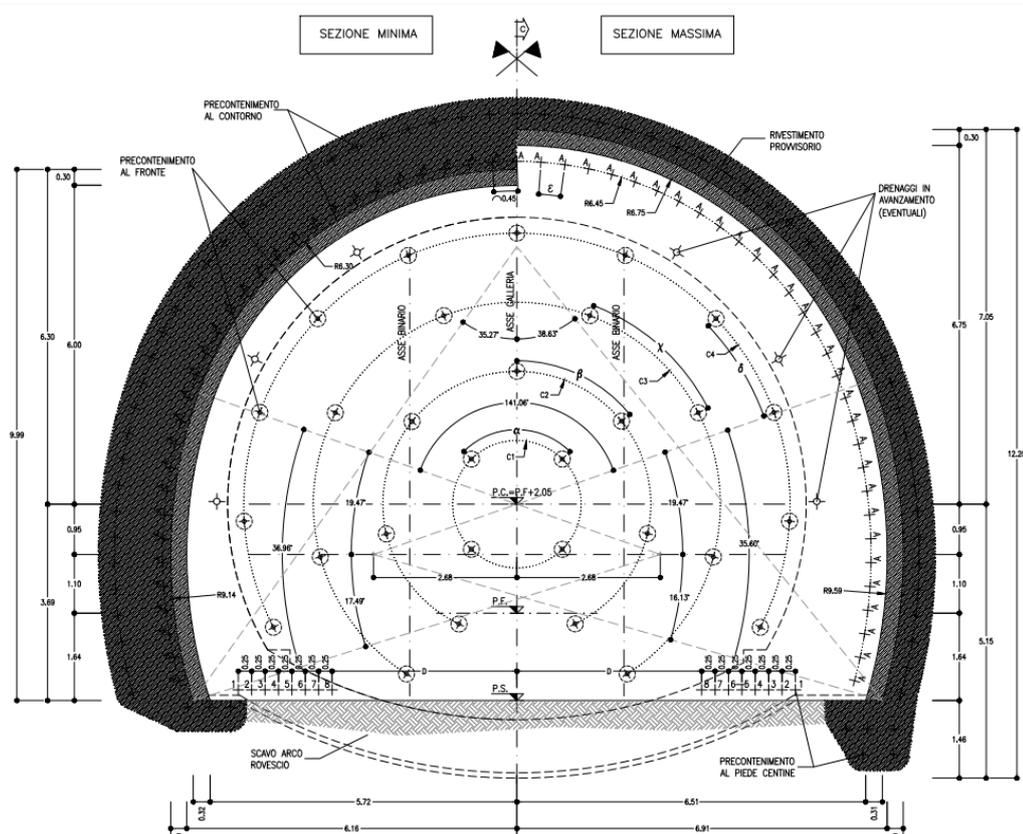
Galleria Cantone. Sezione C1. Scavo e consolidamenti.
